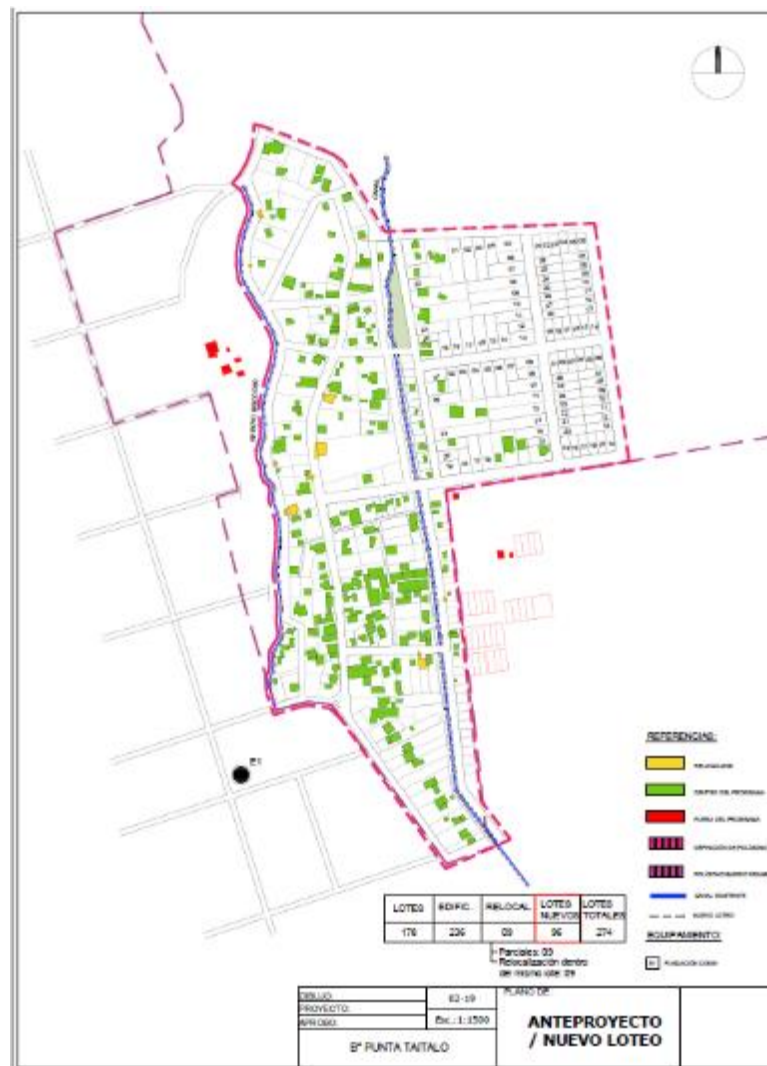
Relevamiento de lotes y edificaciones del Barrio Punta Taitalo
